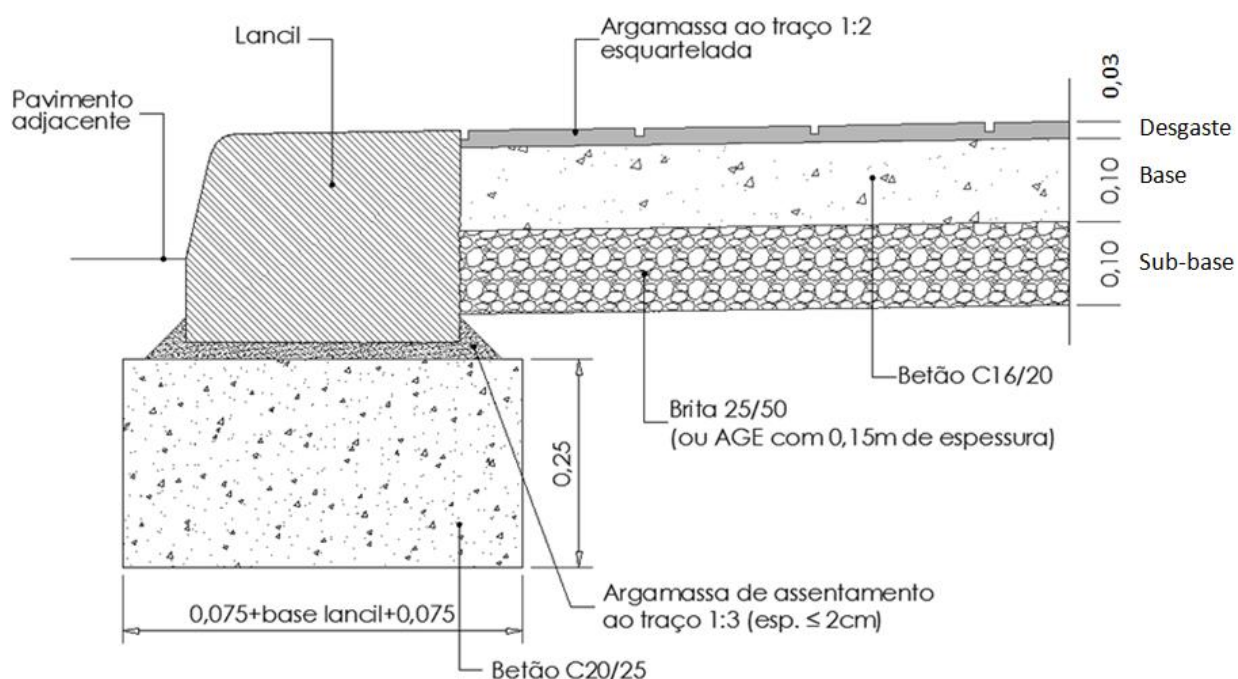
Pormenor construtivo de um passeio em betonilha esquadrelada (adaptado de C. M. do Porto, 2017).
